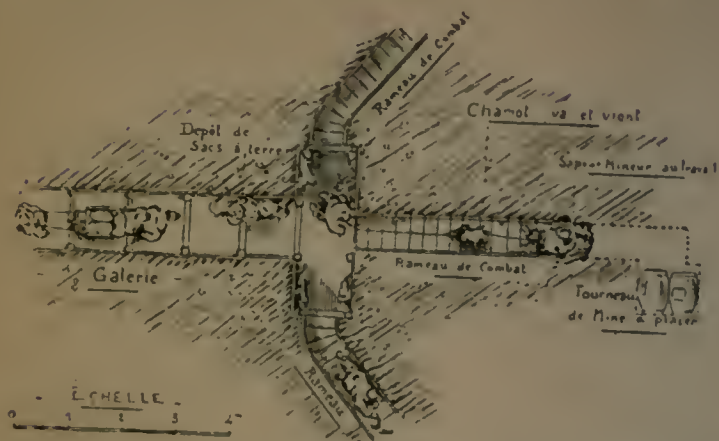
Travail de mine : départ en trois rameaux au fond d'une demi-galerie, en plan.
